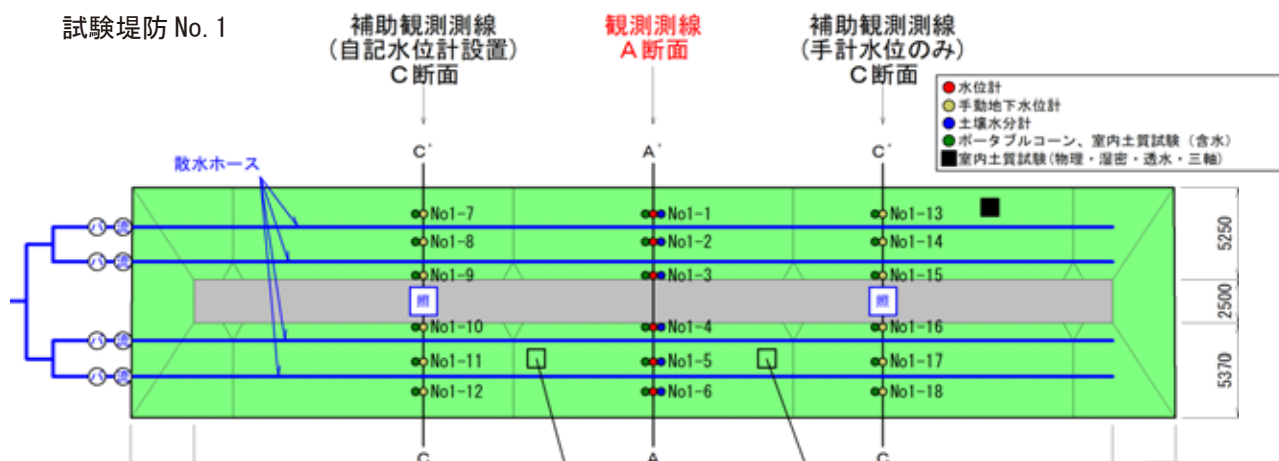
観測箇所平面図 (試験堤防 No. 1)
